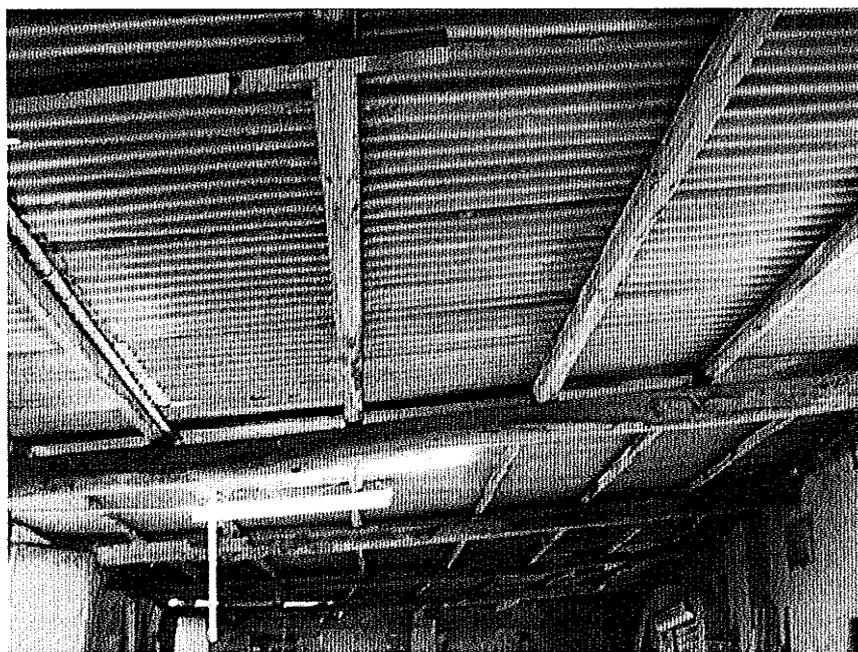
Particolare copertura fabbricato A – Zona Lavorazione
